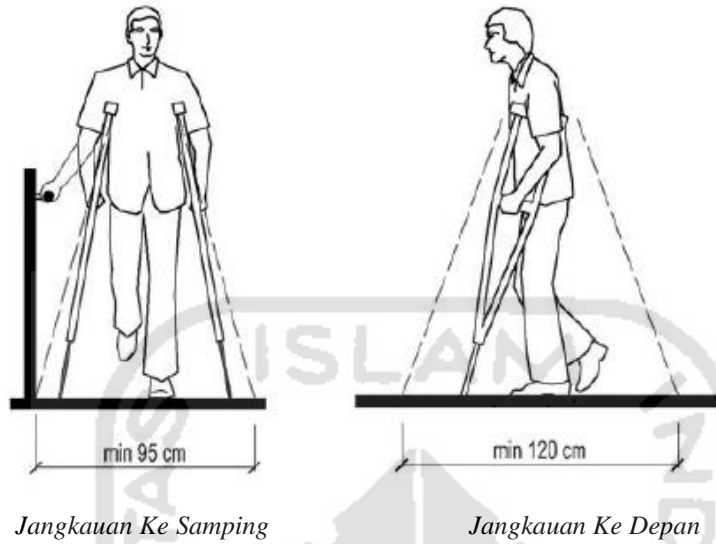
Ruang Gerak Bagi Orang Umum Dewasa
